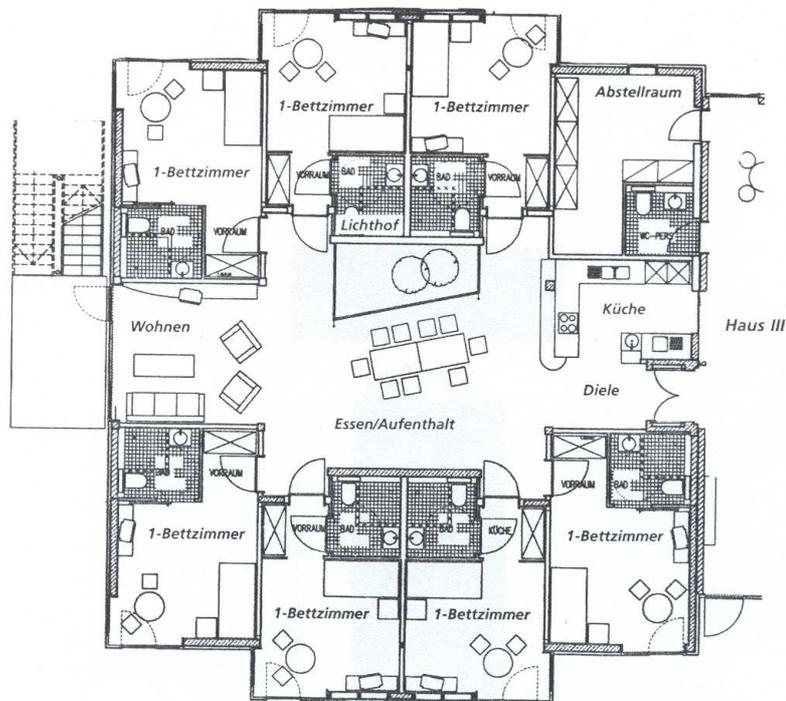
Grundrisszeichnung Hausgemeinschaft Dießen
